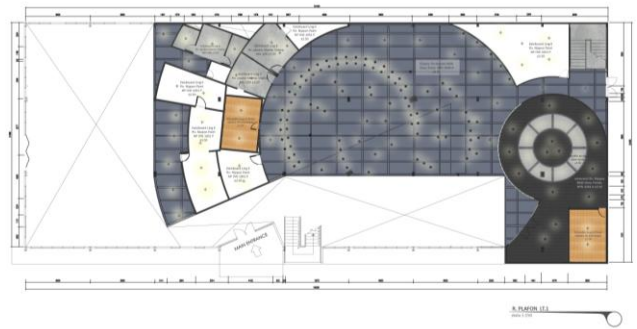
Rencana lantai 2. (Chiong, 2016)
